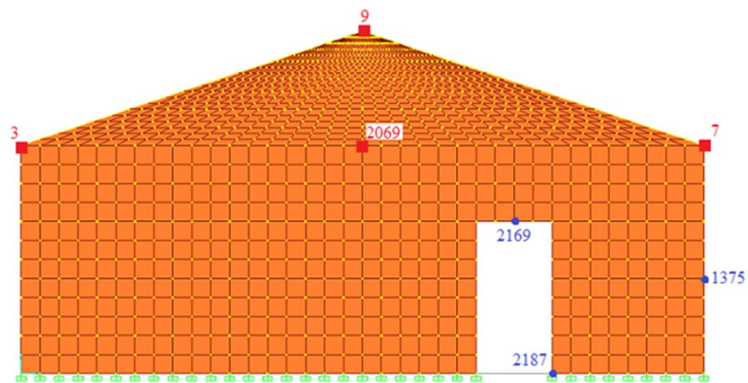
Construção 4.2, rotura por tracção (2)
